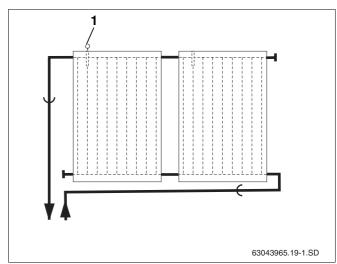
Raccordement hydraulique – conduite de départ gauche
